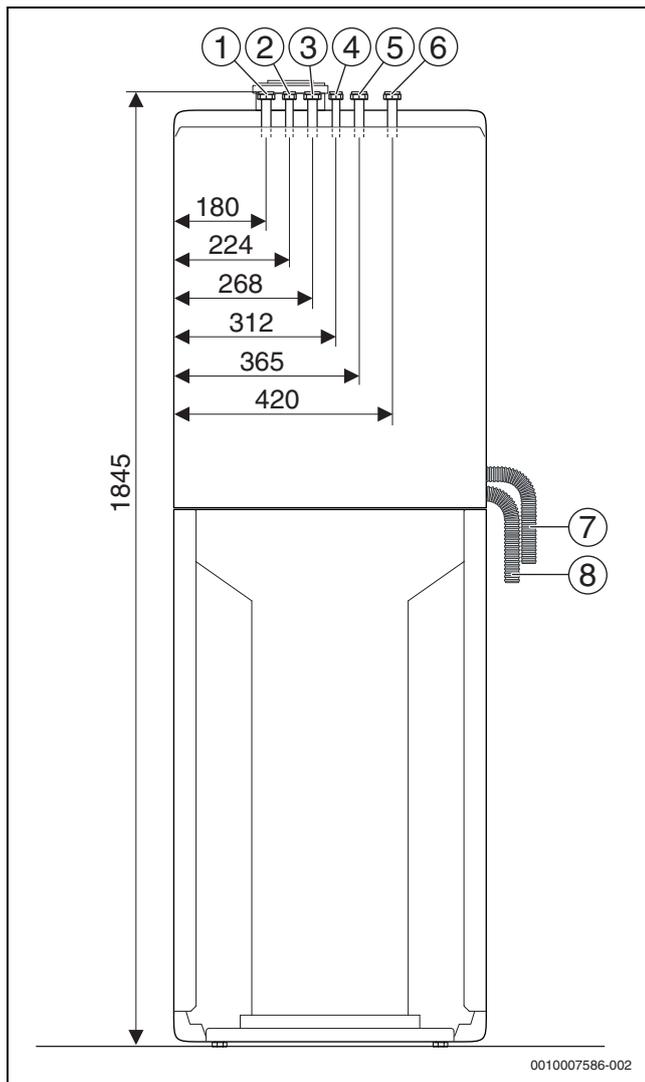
Misure di collegamento dell'accessorio AS-V1/Set di collegamento verticale (misure in mm)
